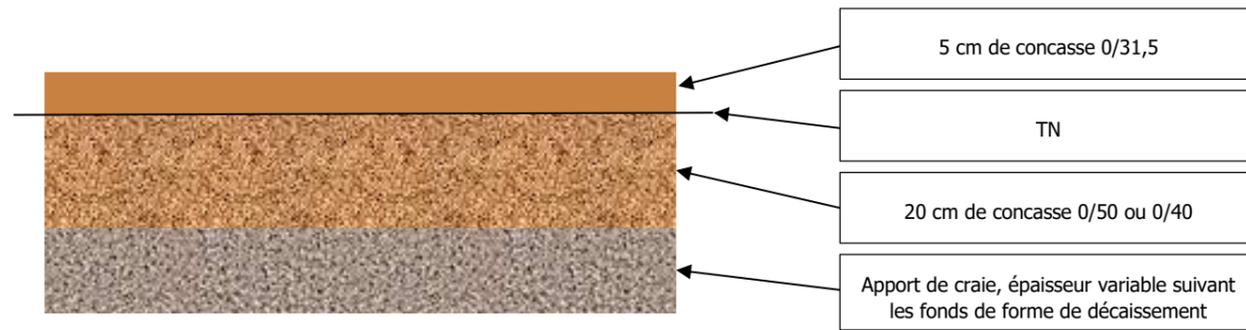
Coupe type des plateformes de levage et création de chemins – Source : An Avel Braz
